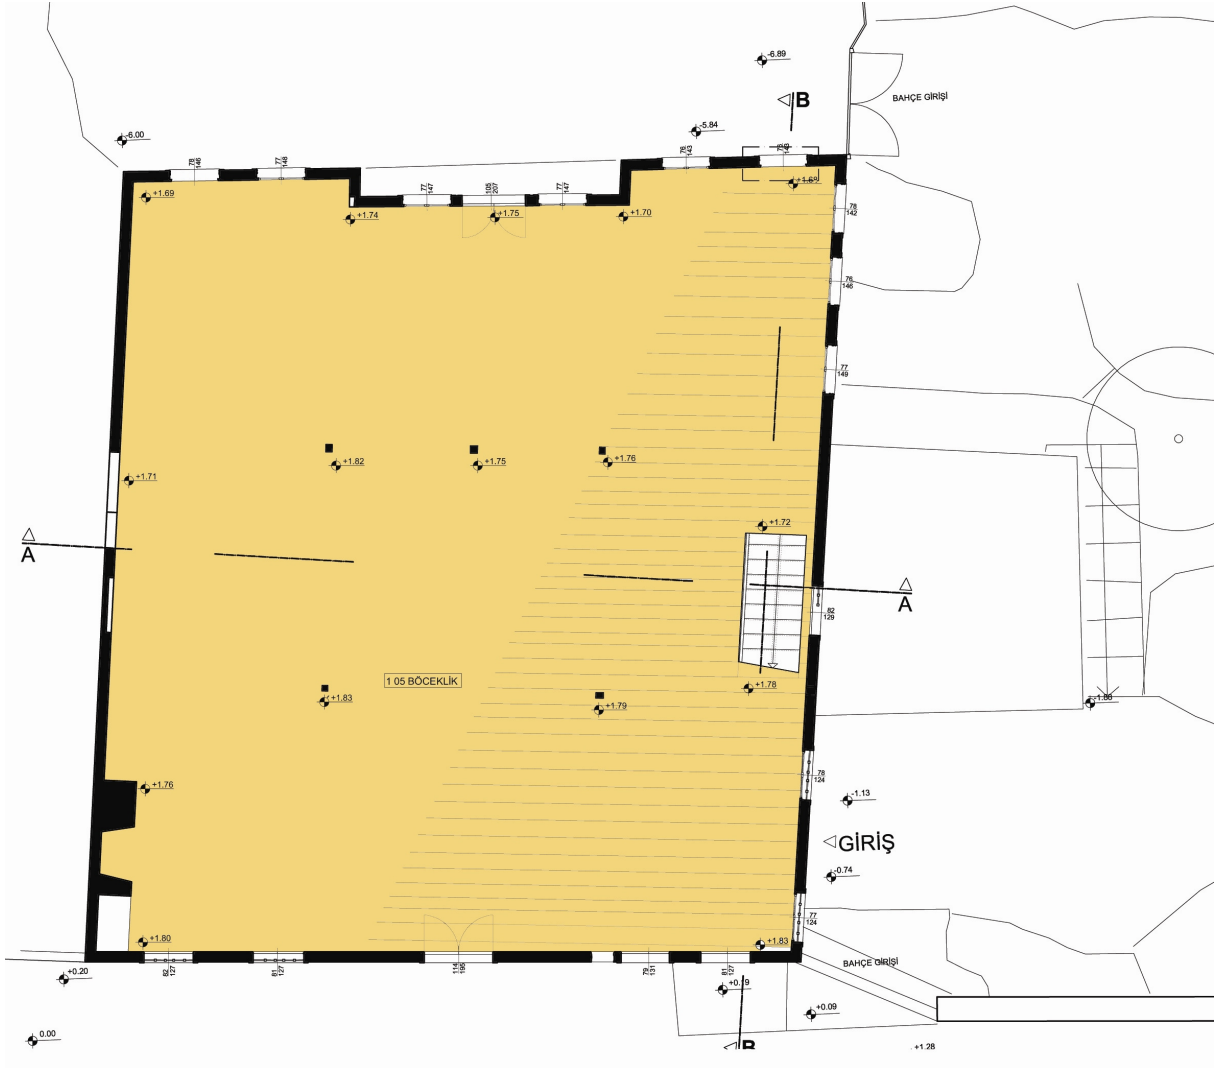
Ellezler konağı zemin kat planı (Rölöve)
